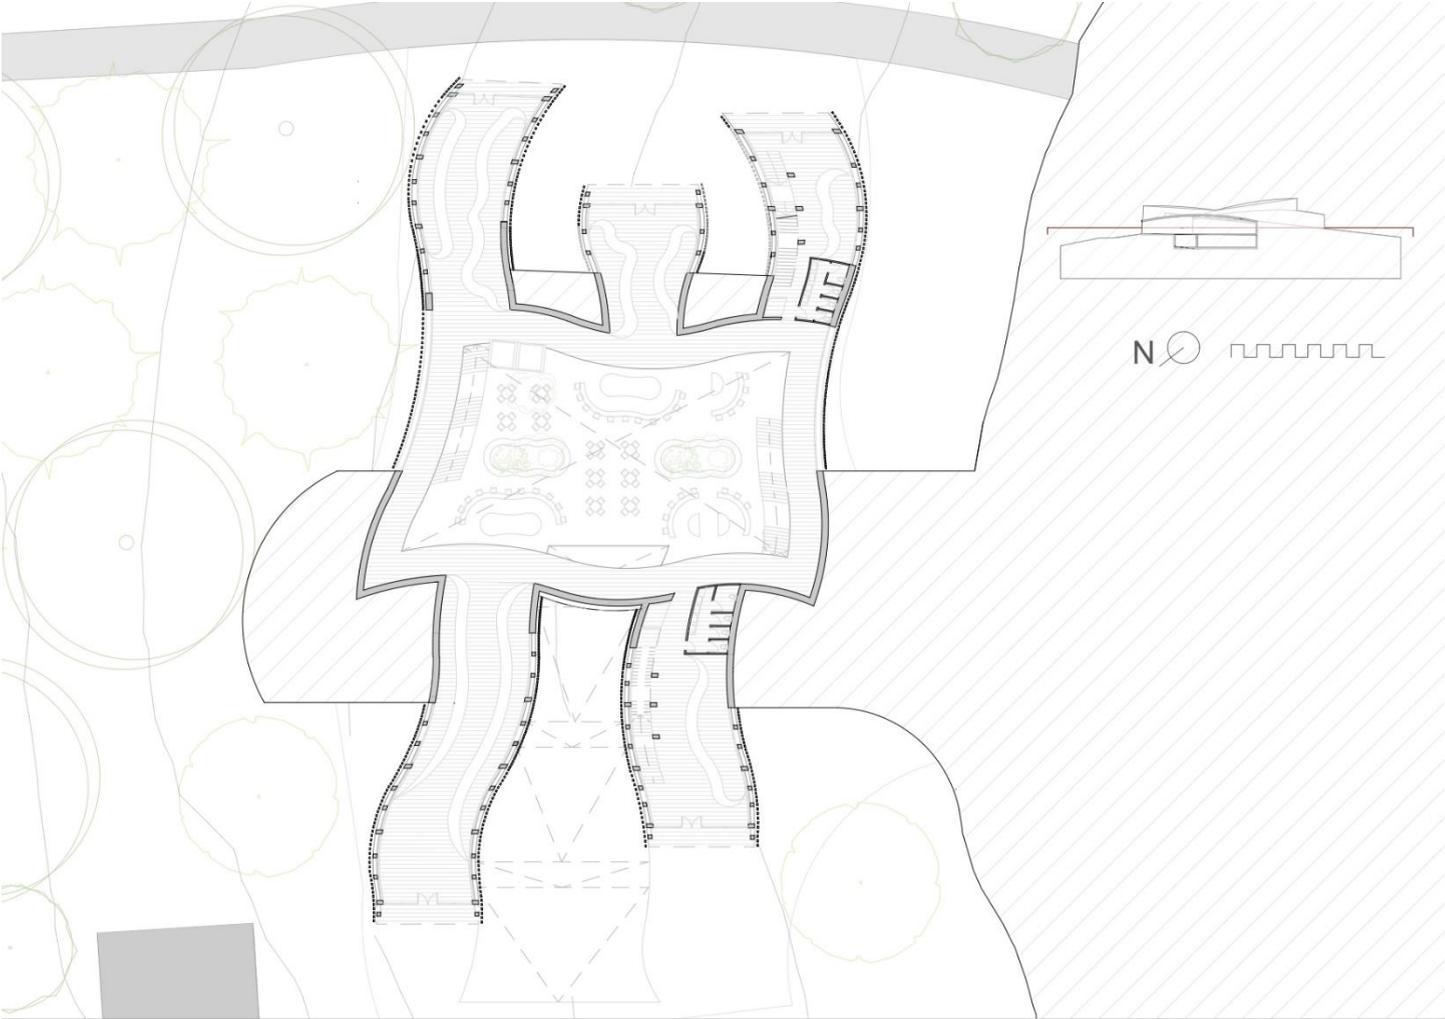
Planta baja. Escala 1:400 Elaboración propia.
